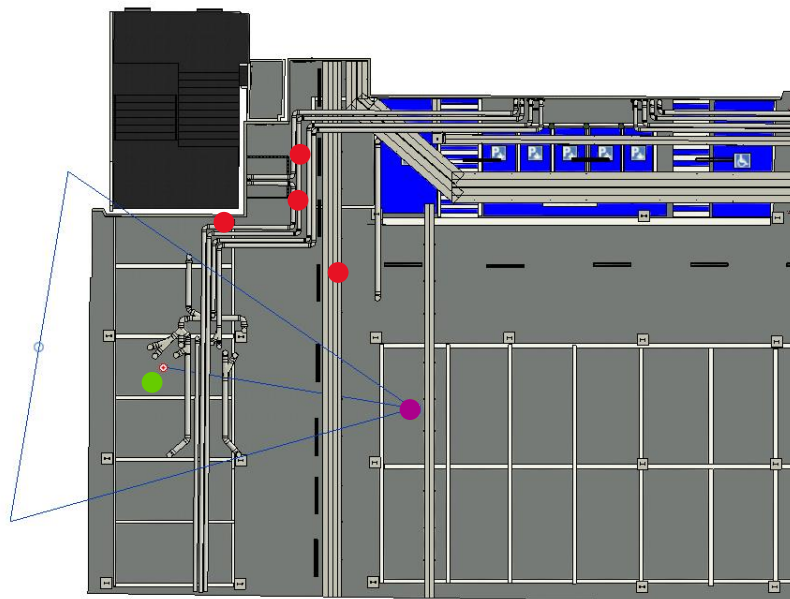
Plano Estación número 2 Fuente: Elaboración Propia
